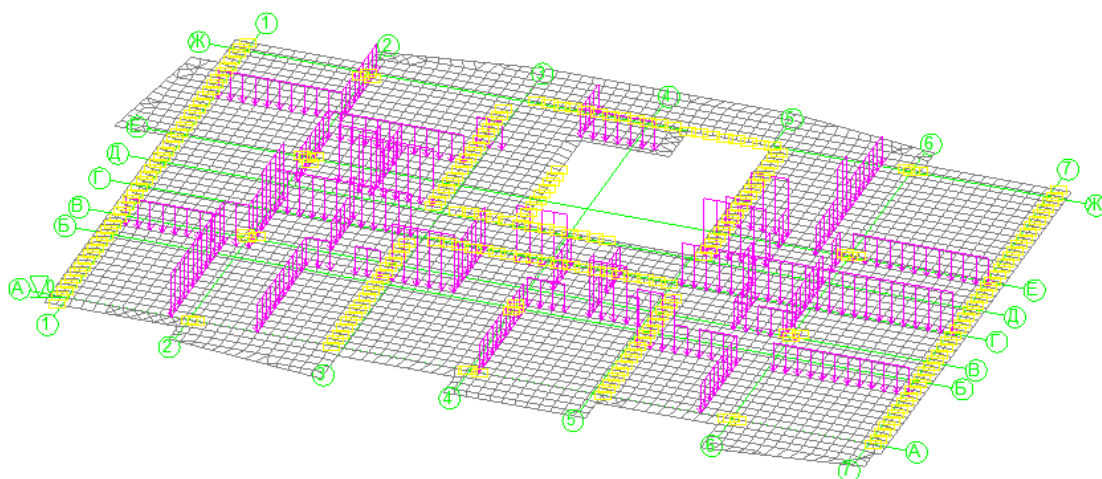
Схема приложения нагрузки от веса перегородок
